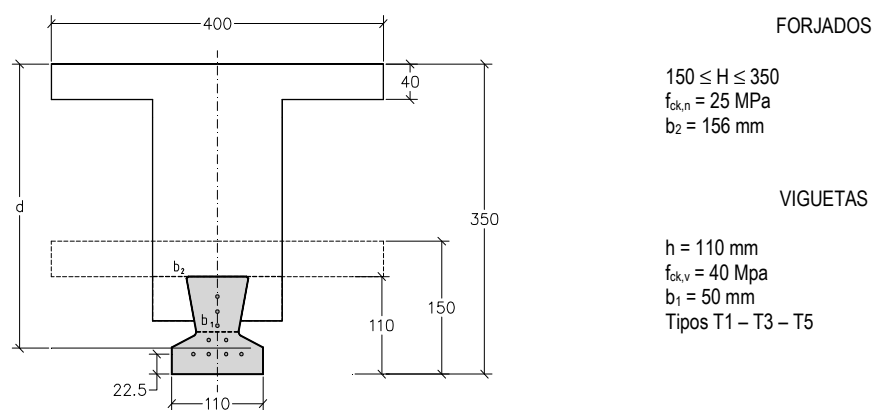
a. Esquema de forjado analizado
